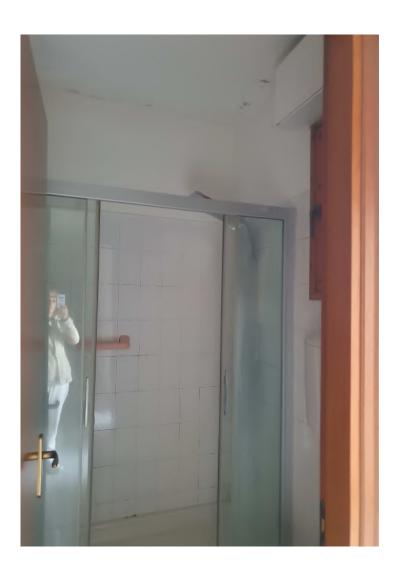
Camera singola: presenza di muffa sulla parete e sugli angoli
